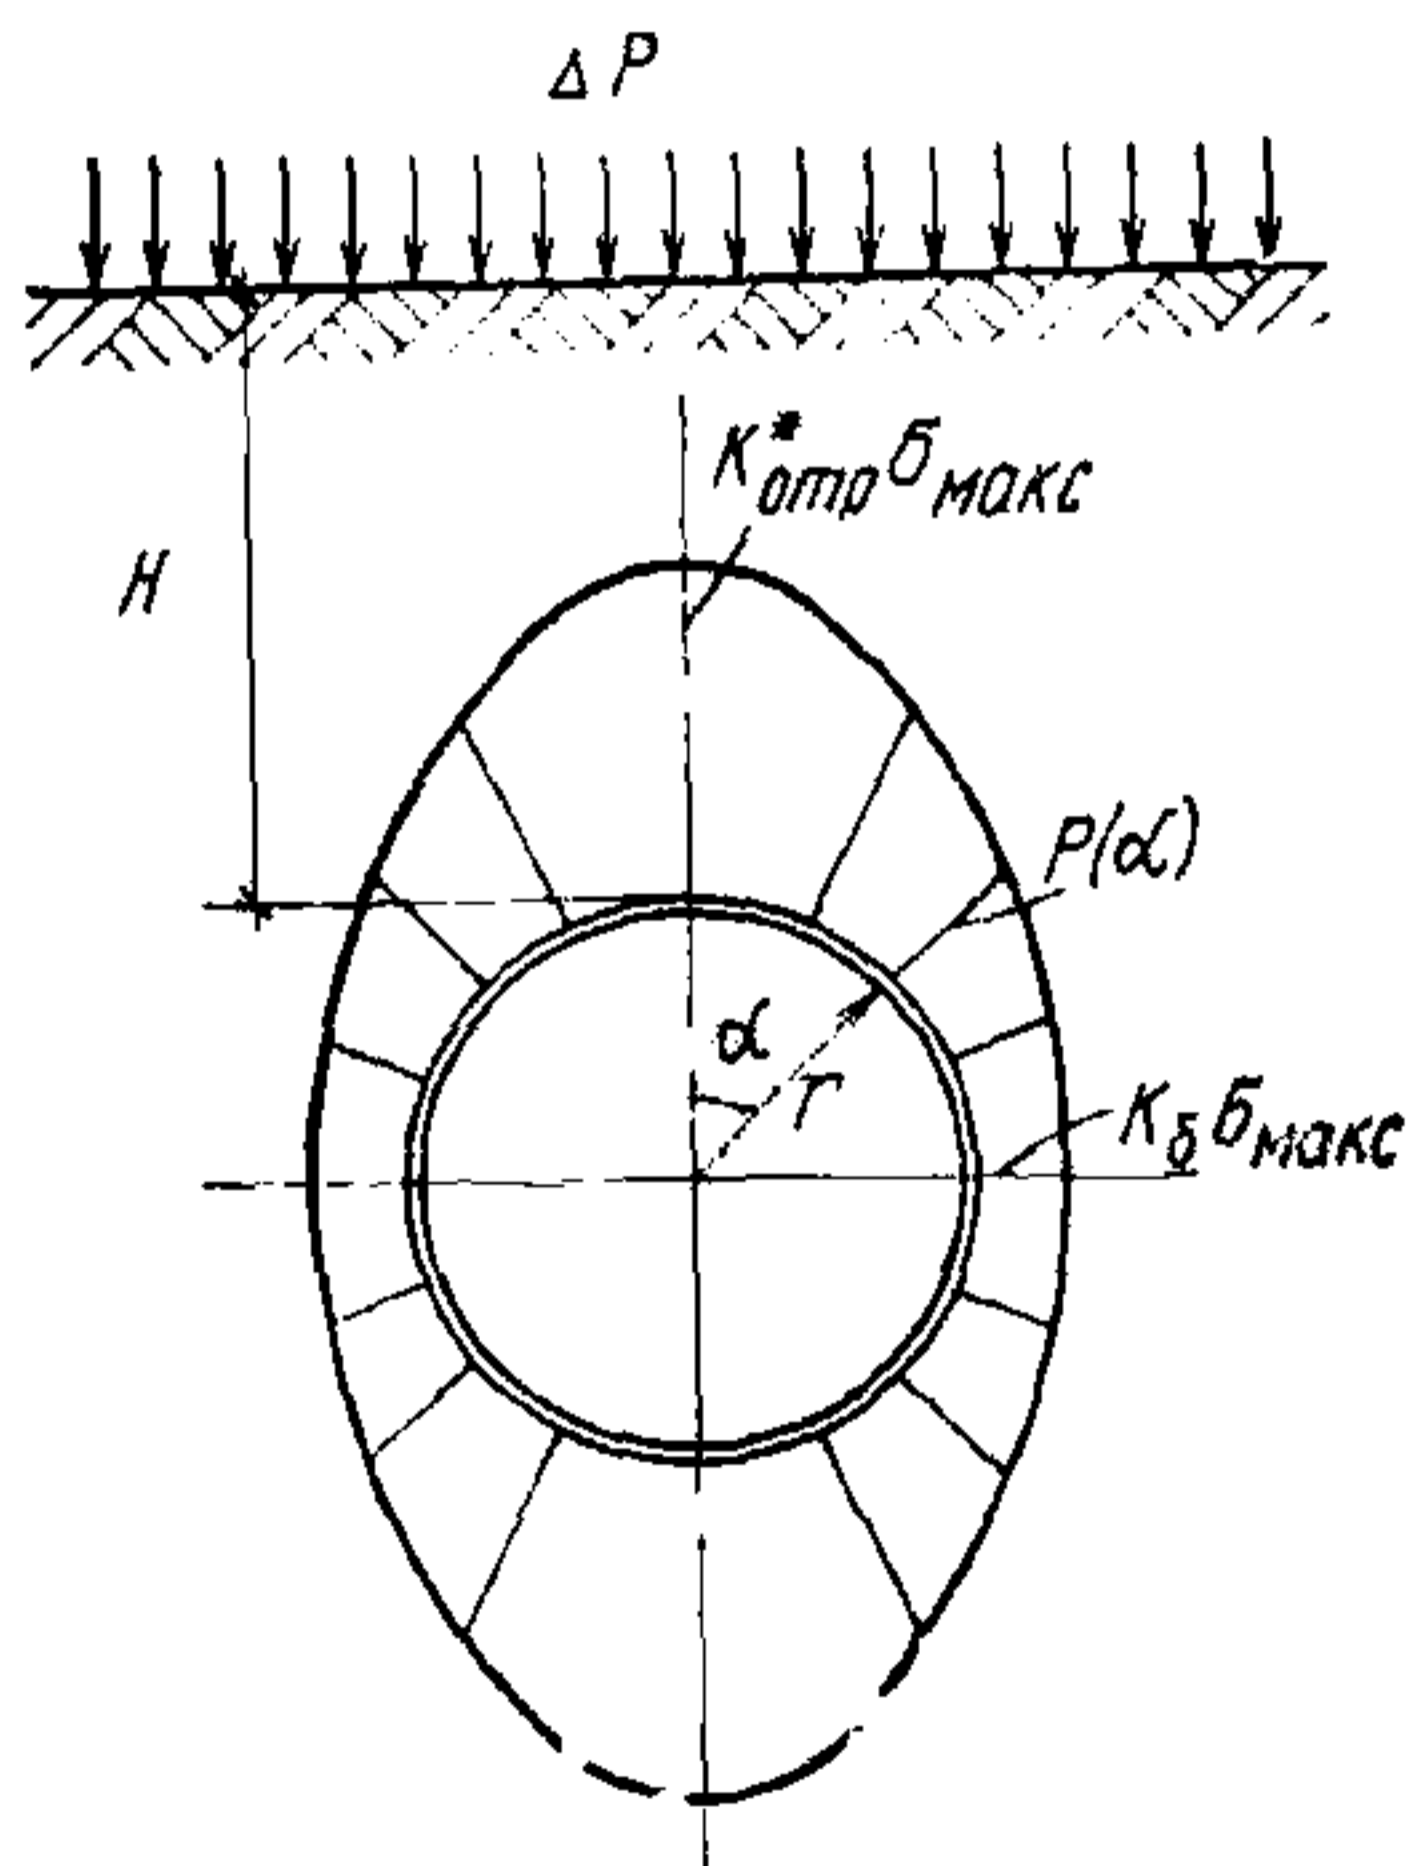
Схема внешнего нагружения цилиндрической трубы
